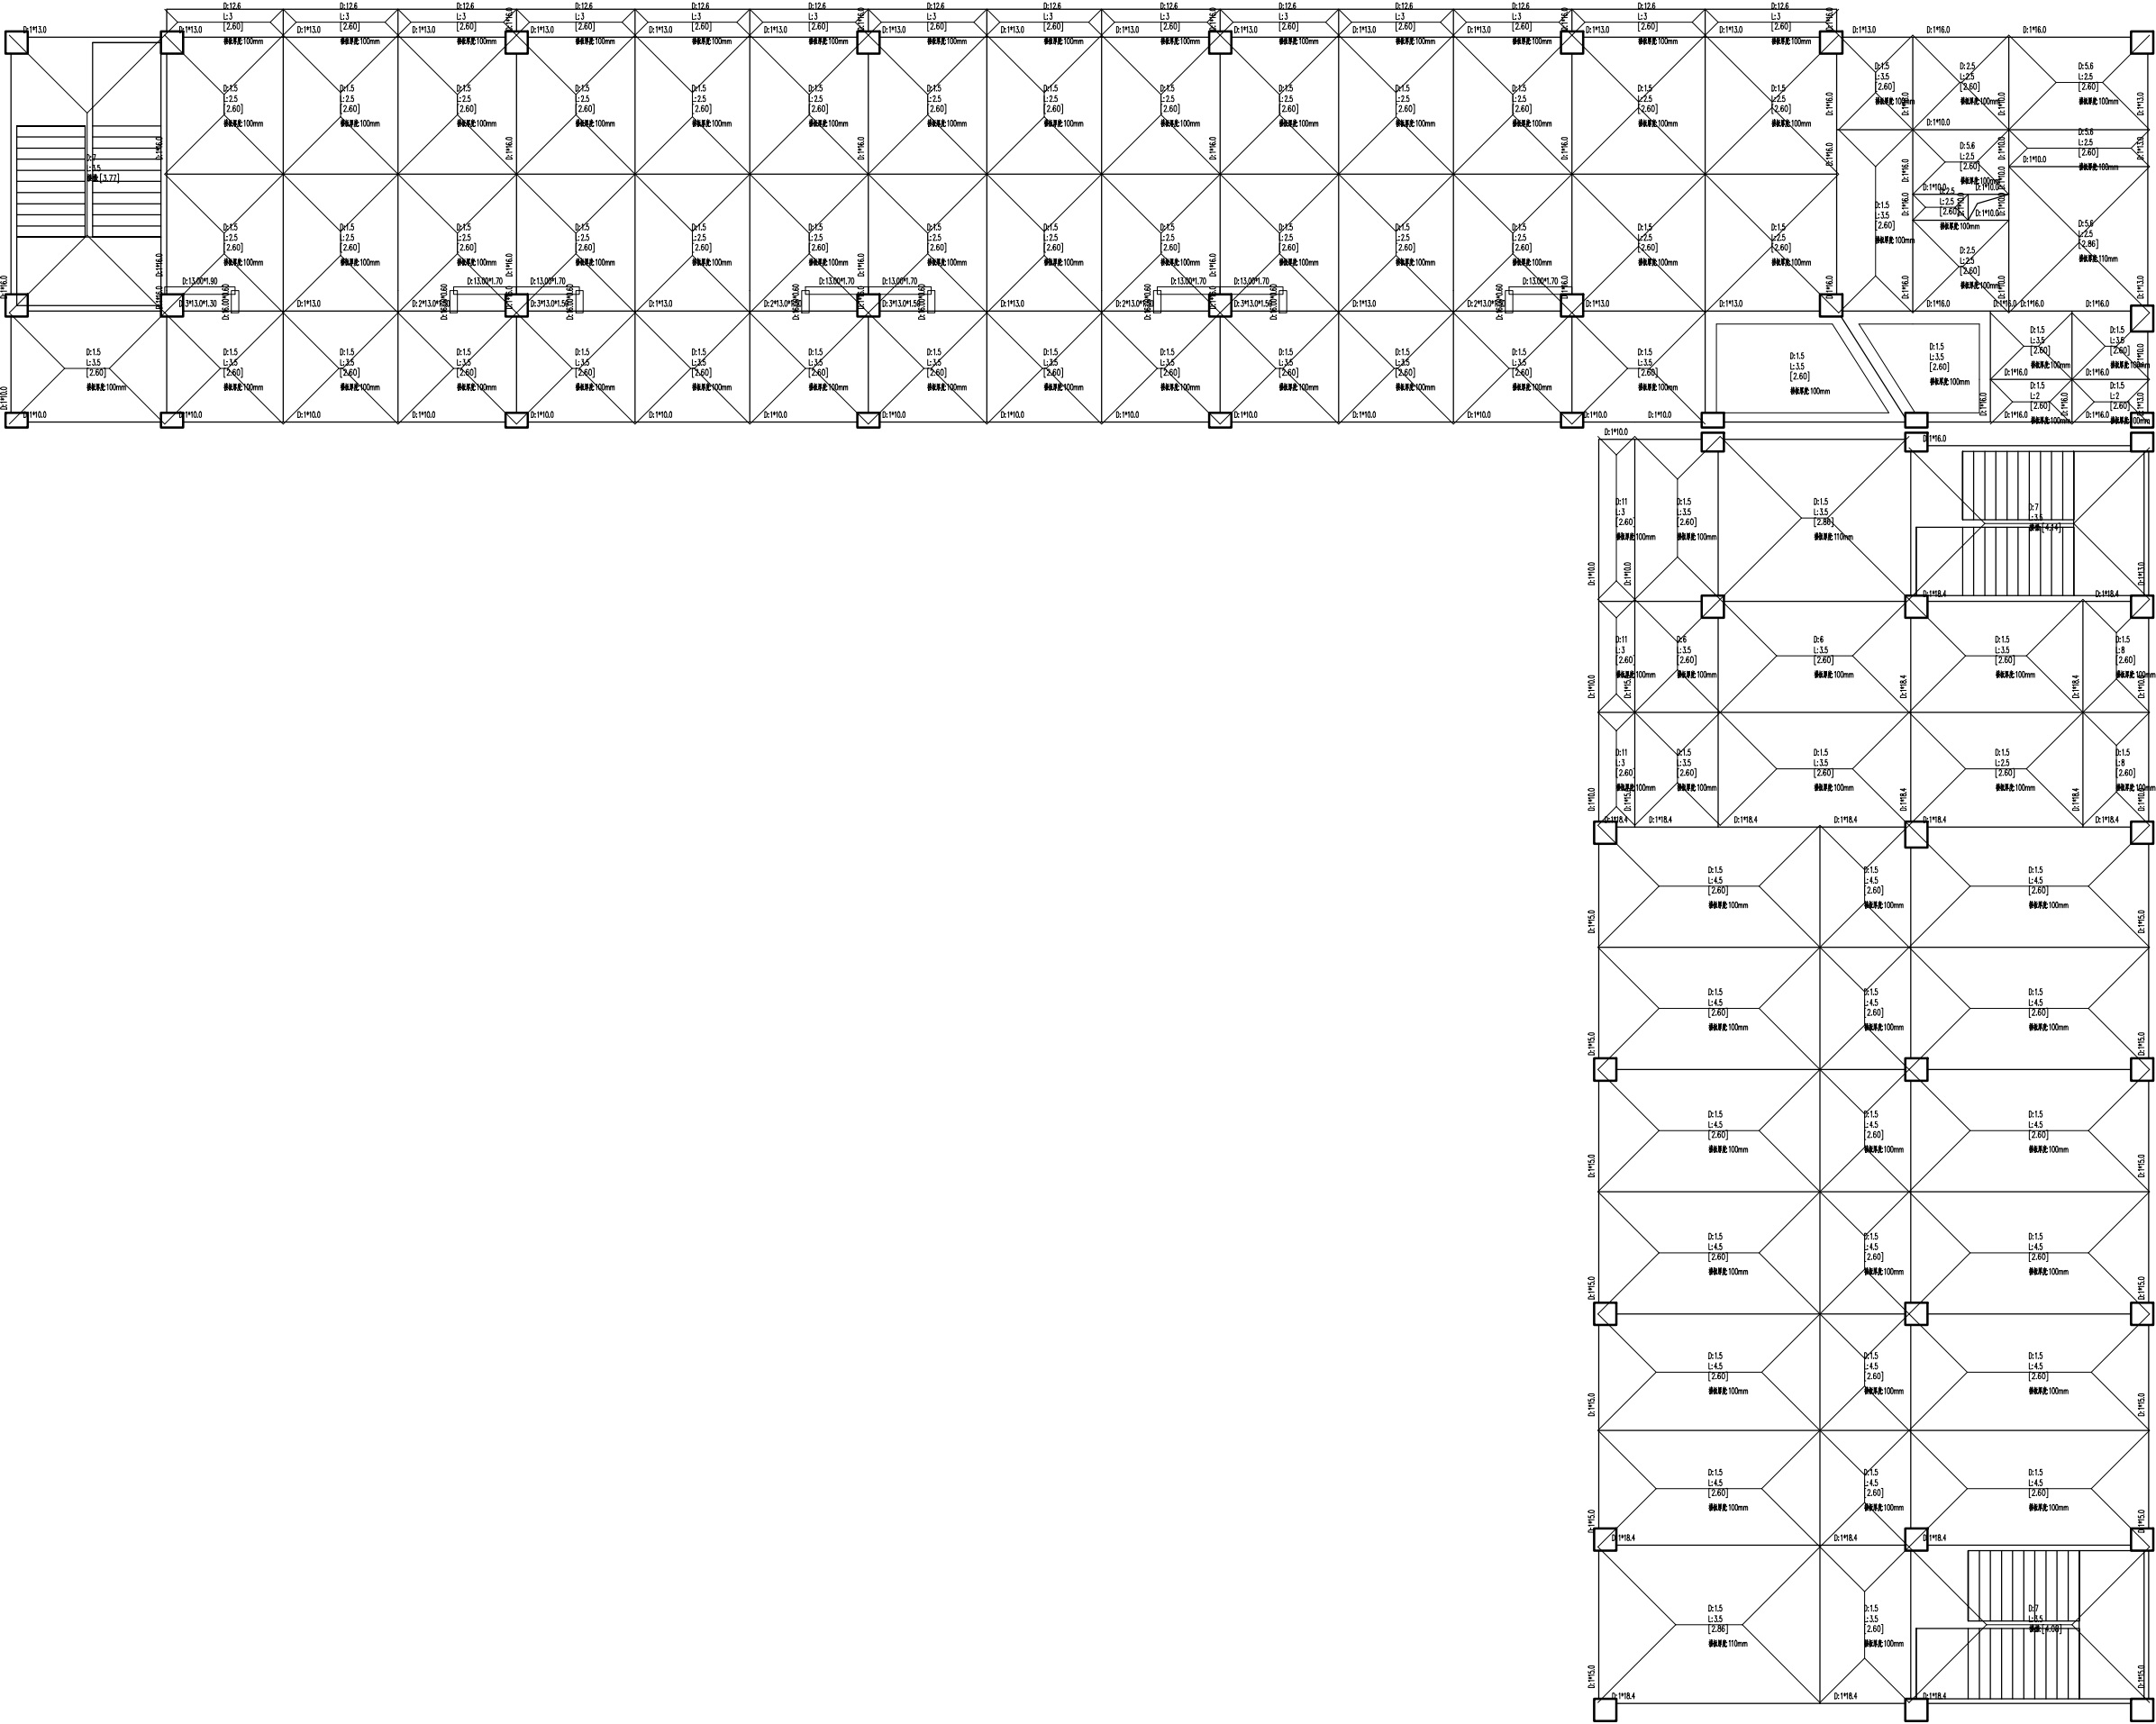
建筑、结构、设备用房平面布置图 [单位: m]
